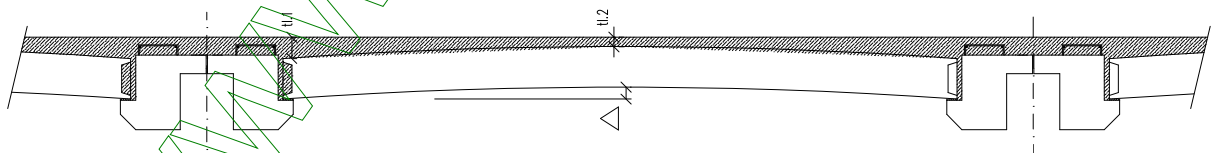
KIKA Čestlice – stropní konstrukce s příčným řezem v úložné oblasti na sloupu
